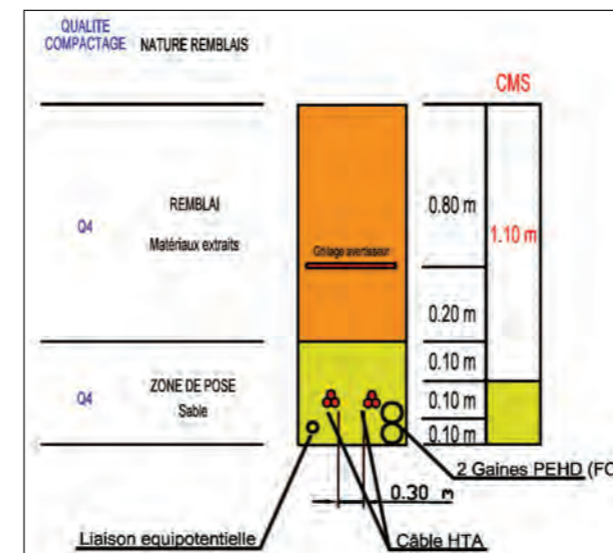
COUPES D'ENFOUSSEMENT TYPE DU CÂBLE
